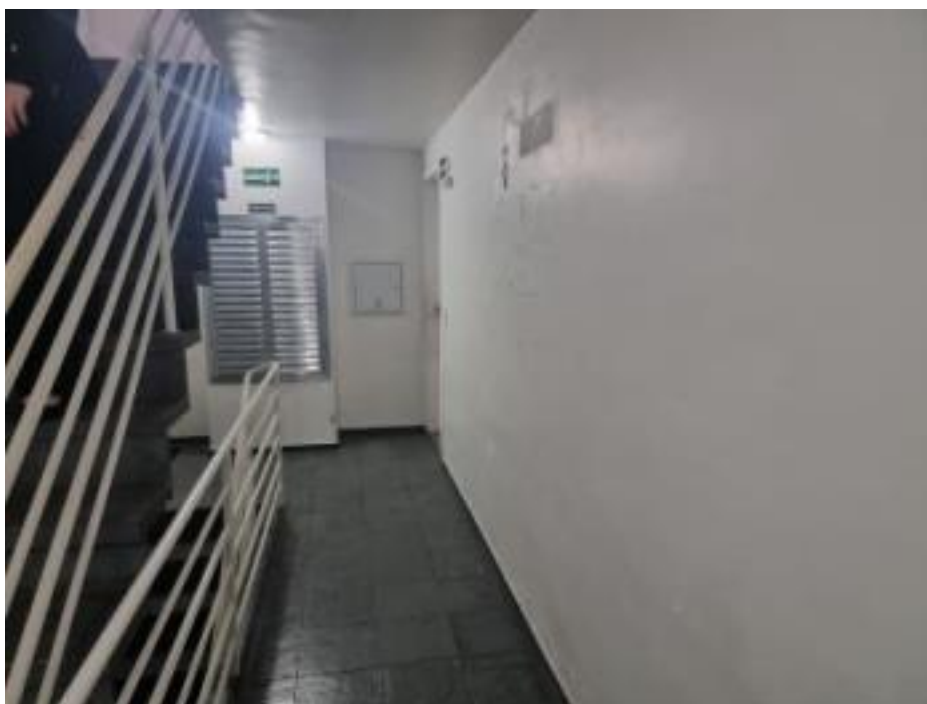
FOTO DA NUMERAÇÃO NA PORTA DO I.A
